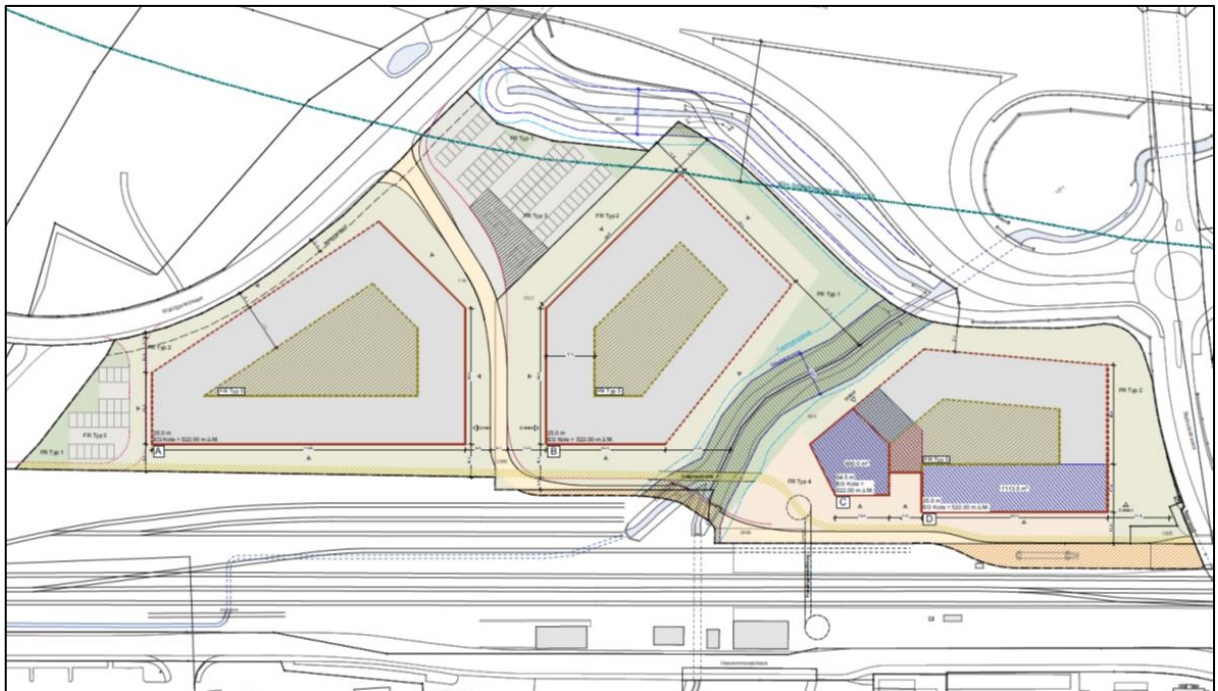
Bebauungsplan Rothenburg Station Ost mit Baubereichen
